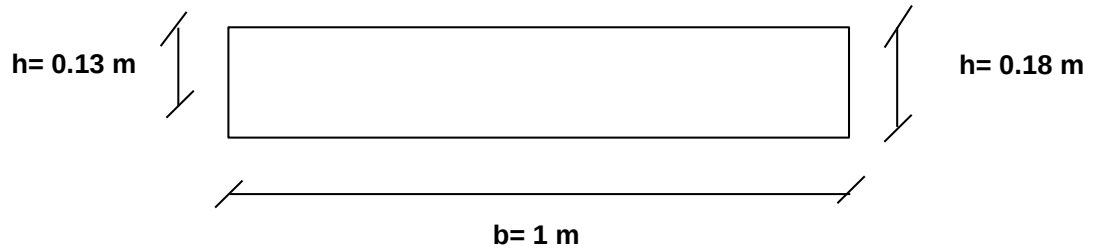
Sección longitudinal de la losa tomada para el diseño de la armadura.
